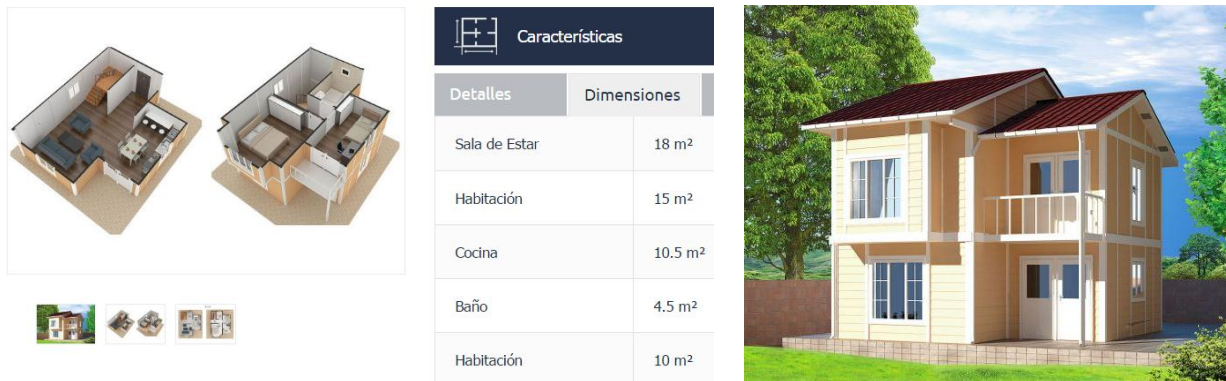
Construcciones Modulares Karmod. Casas prefabricadas con paneles de concreto [26].
